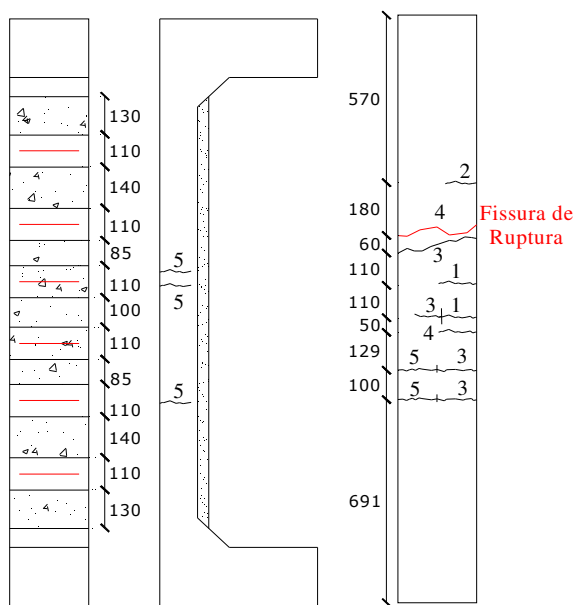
Mapa de fissuração dos pilares P3, P4, P5 e P6
